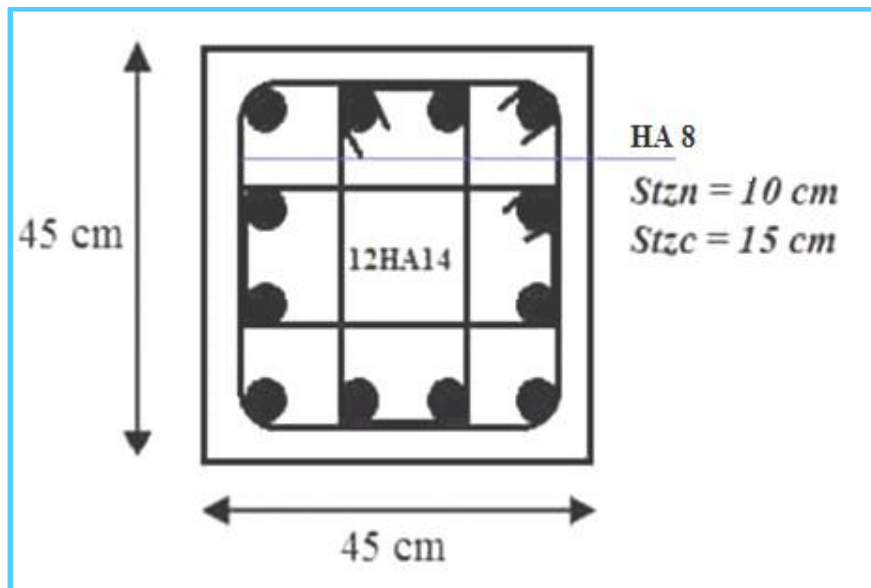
Schéma de ferrailage de poteau 45x45.
